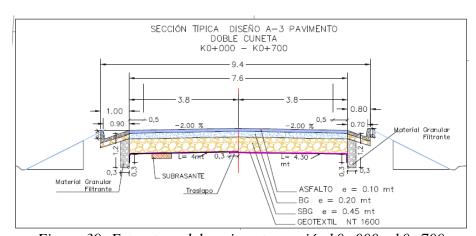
Estructura del pavimento sección k0+000 a k0+700
